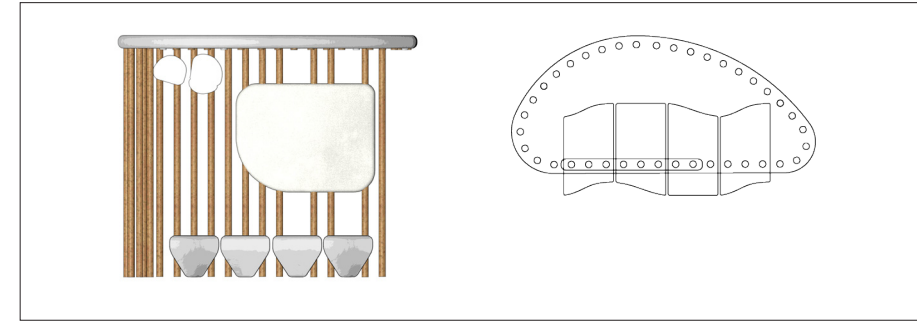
Alzado y planta de la propuesta que ocupa 4 m².
